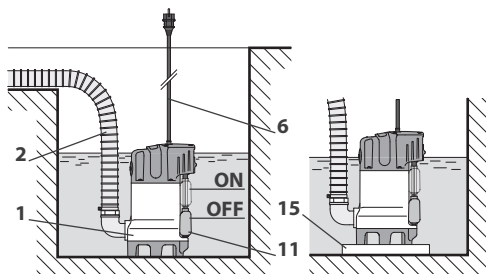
Installation fixe avec tuyau de refoulement flexible.
